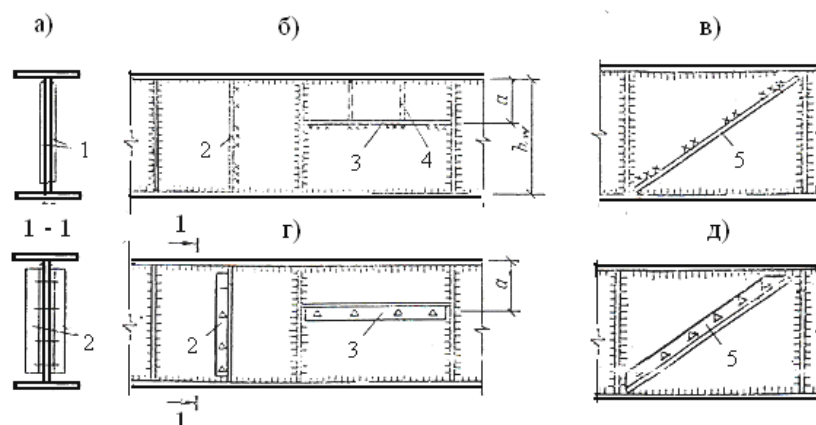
Схемы местного усиления стенок двутавровых балок:
